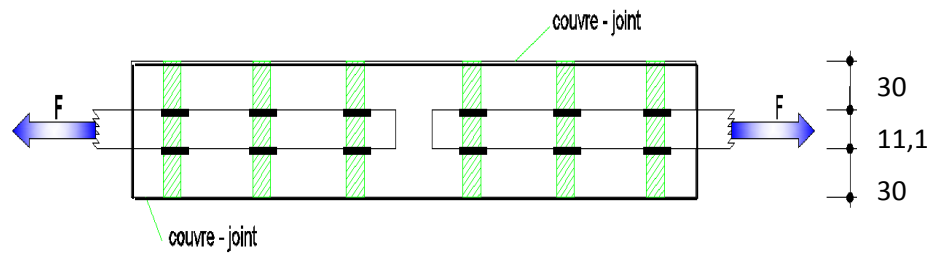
Coupe longitudinale d'un assemblage par couvre joint
